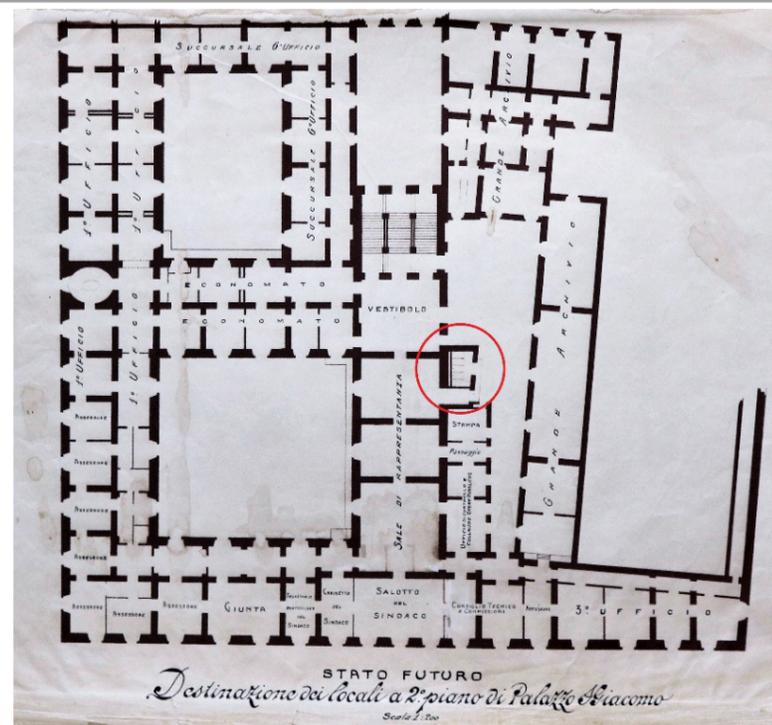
Pianta progetto piano secondo. (ASMUN, Fondo Cartografico, Quartiere san Ferdinando).
